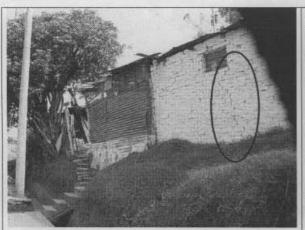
Fachada de la edificación en las condiciones presentes al momento de la visita. Agrietamiento del muro de fachada e inclinación del inmueble sobre la ladera.
